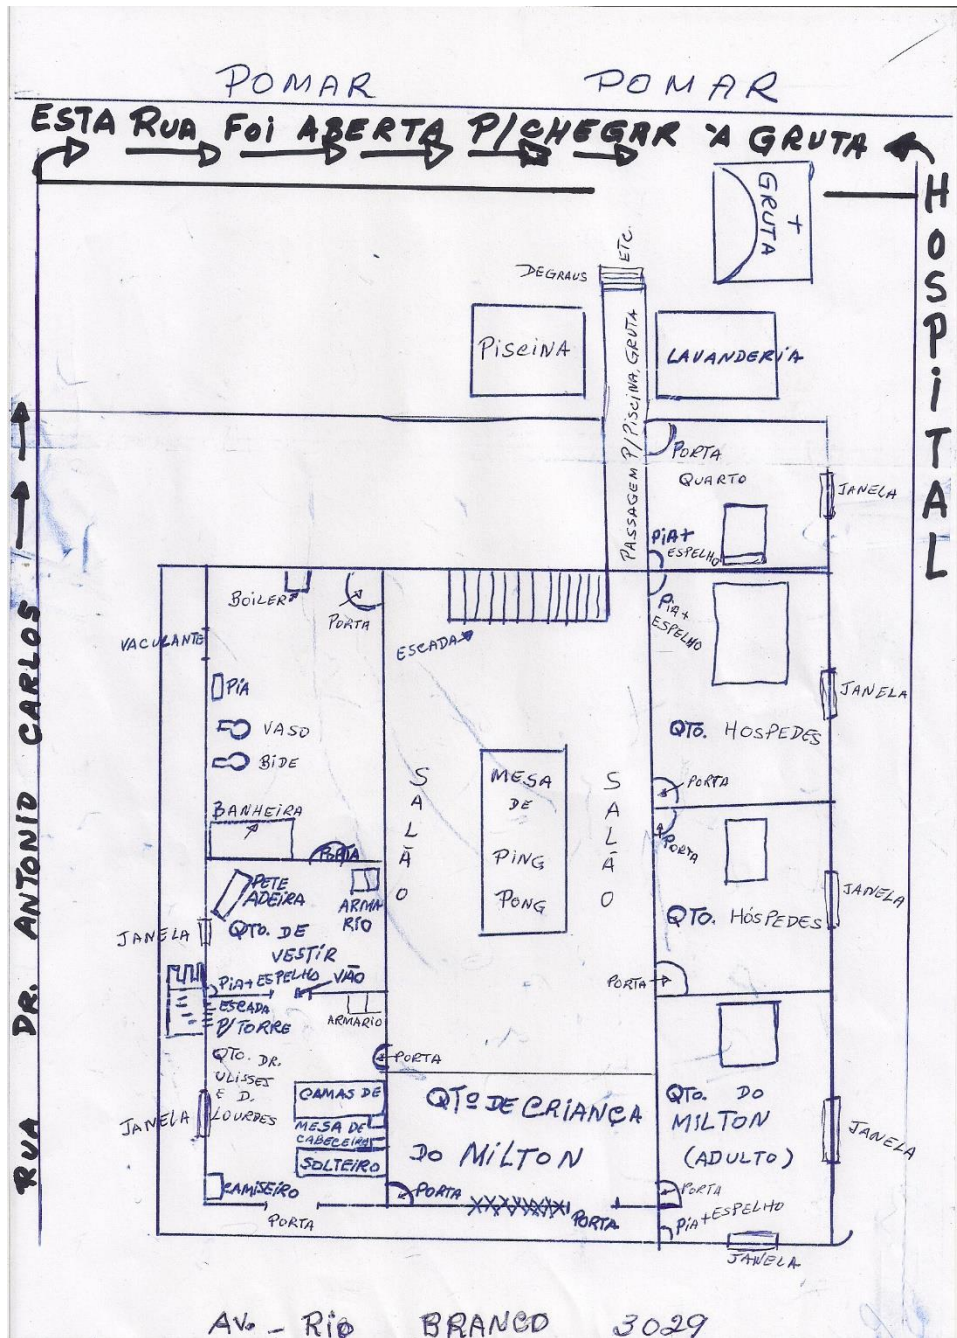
Croqui da planta do segundo pavimento do Castelinho
